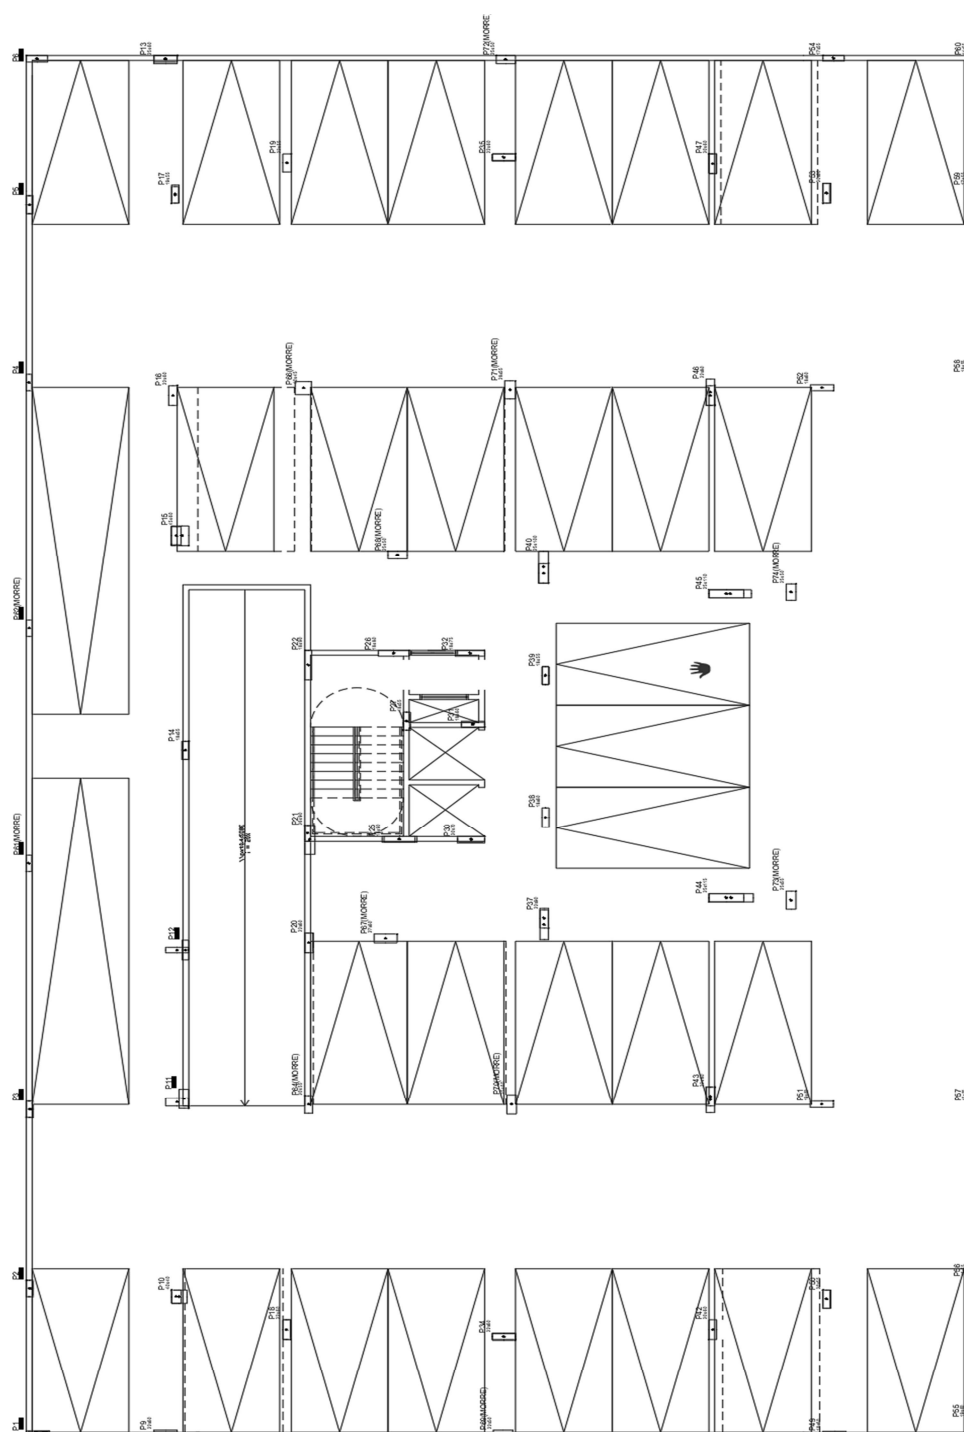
Pilar 34 (tipo 1) com indicação das vagas de garagem no pavimento teto térreo
